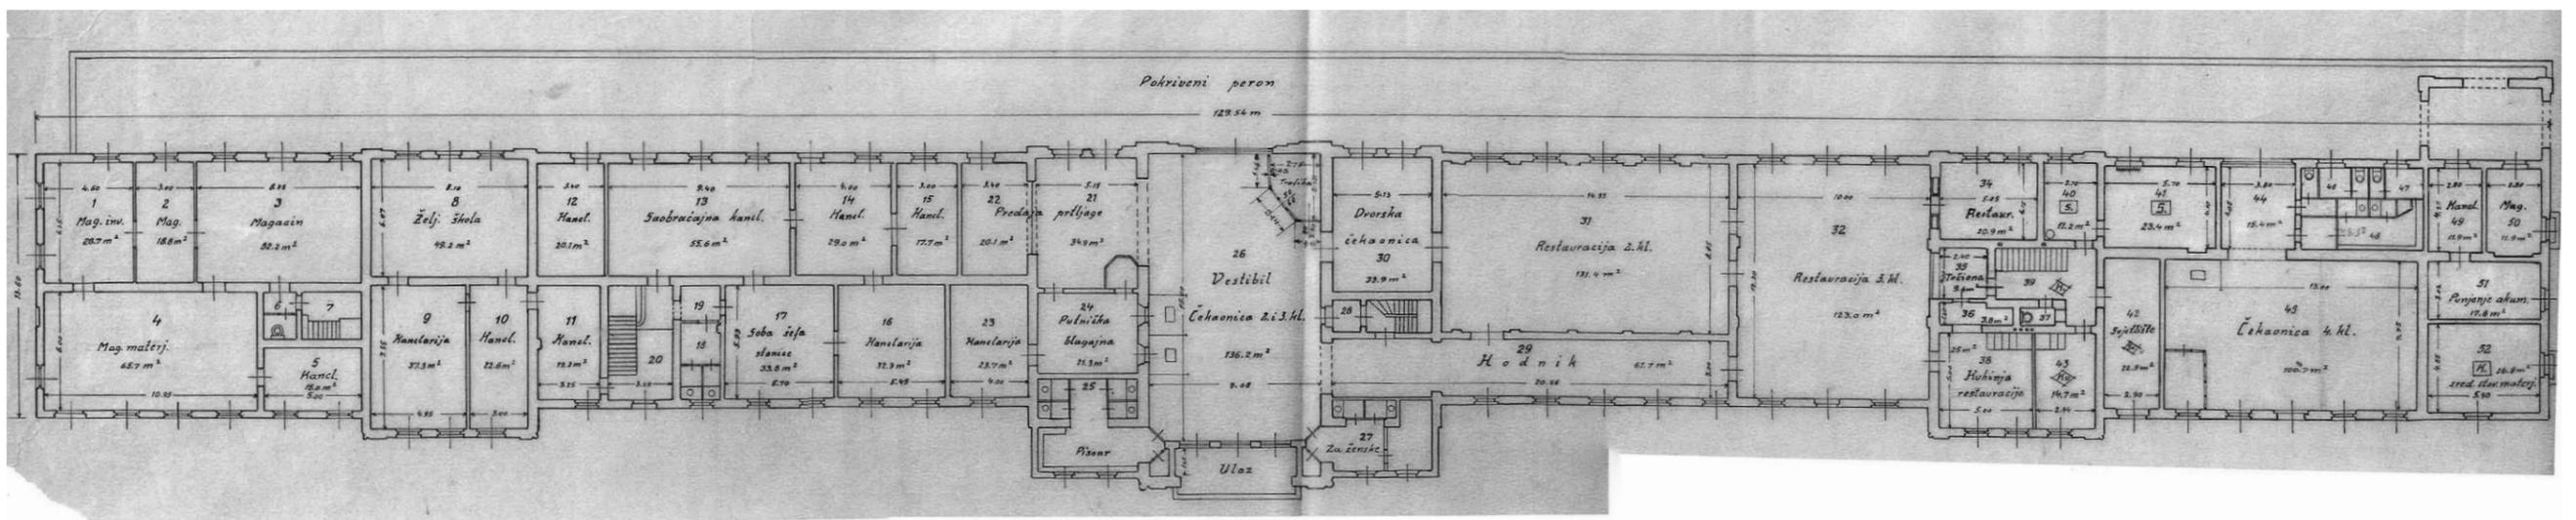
Grundriss Erdgeschoß, 1907
